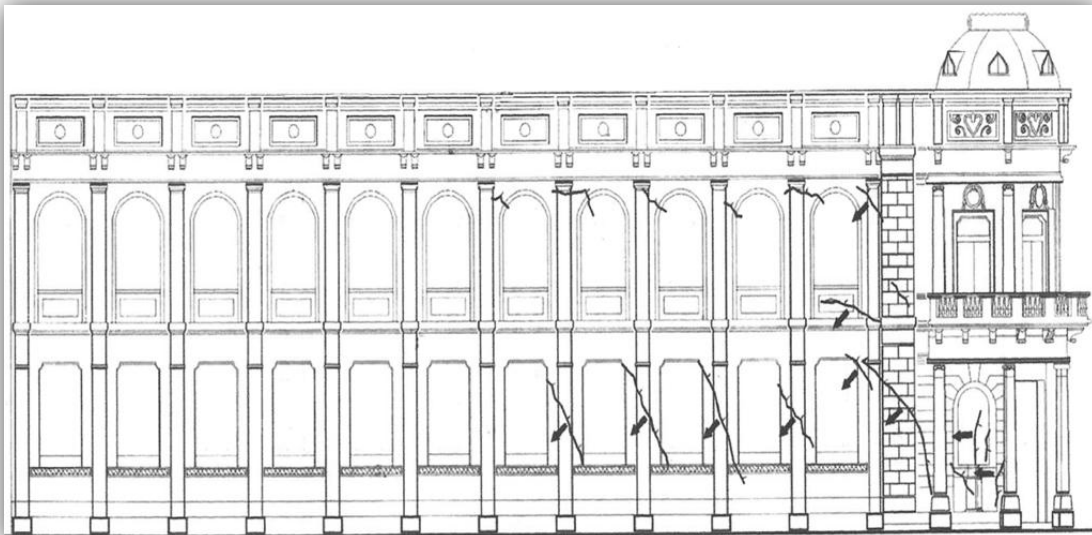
Levantamiento de grietas en fachada Norte, (1995) [2.17].
